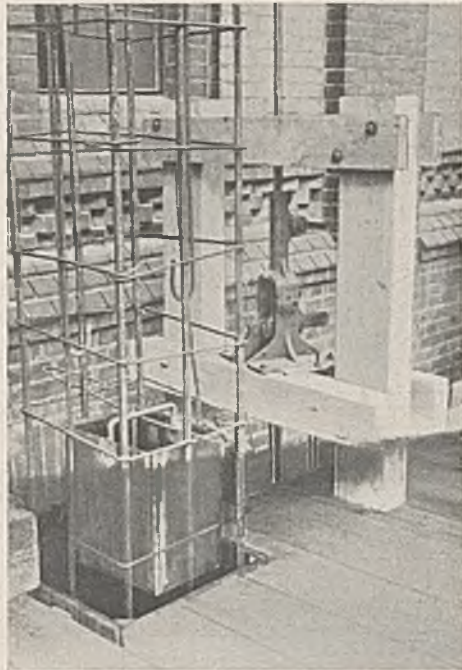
Herstellen der Aussparungen für die Eisenbetonbalken, mit Hilfe von mit Sand gefüllten Blechkasten.
